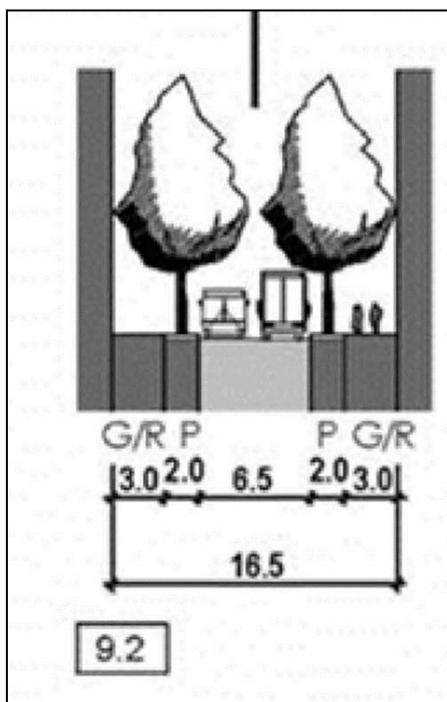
Empfohlener Querschnitt - Gewerbestraße nach RAS06
